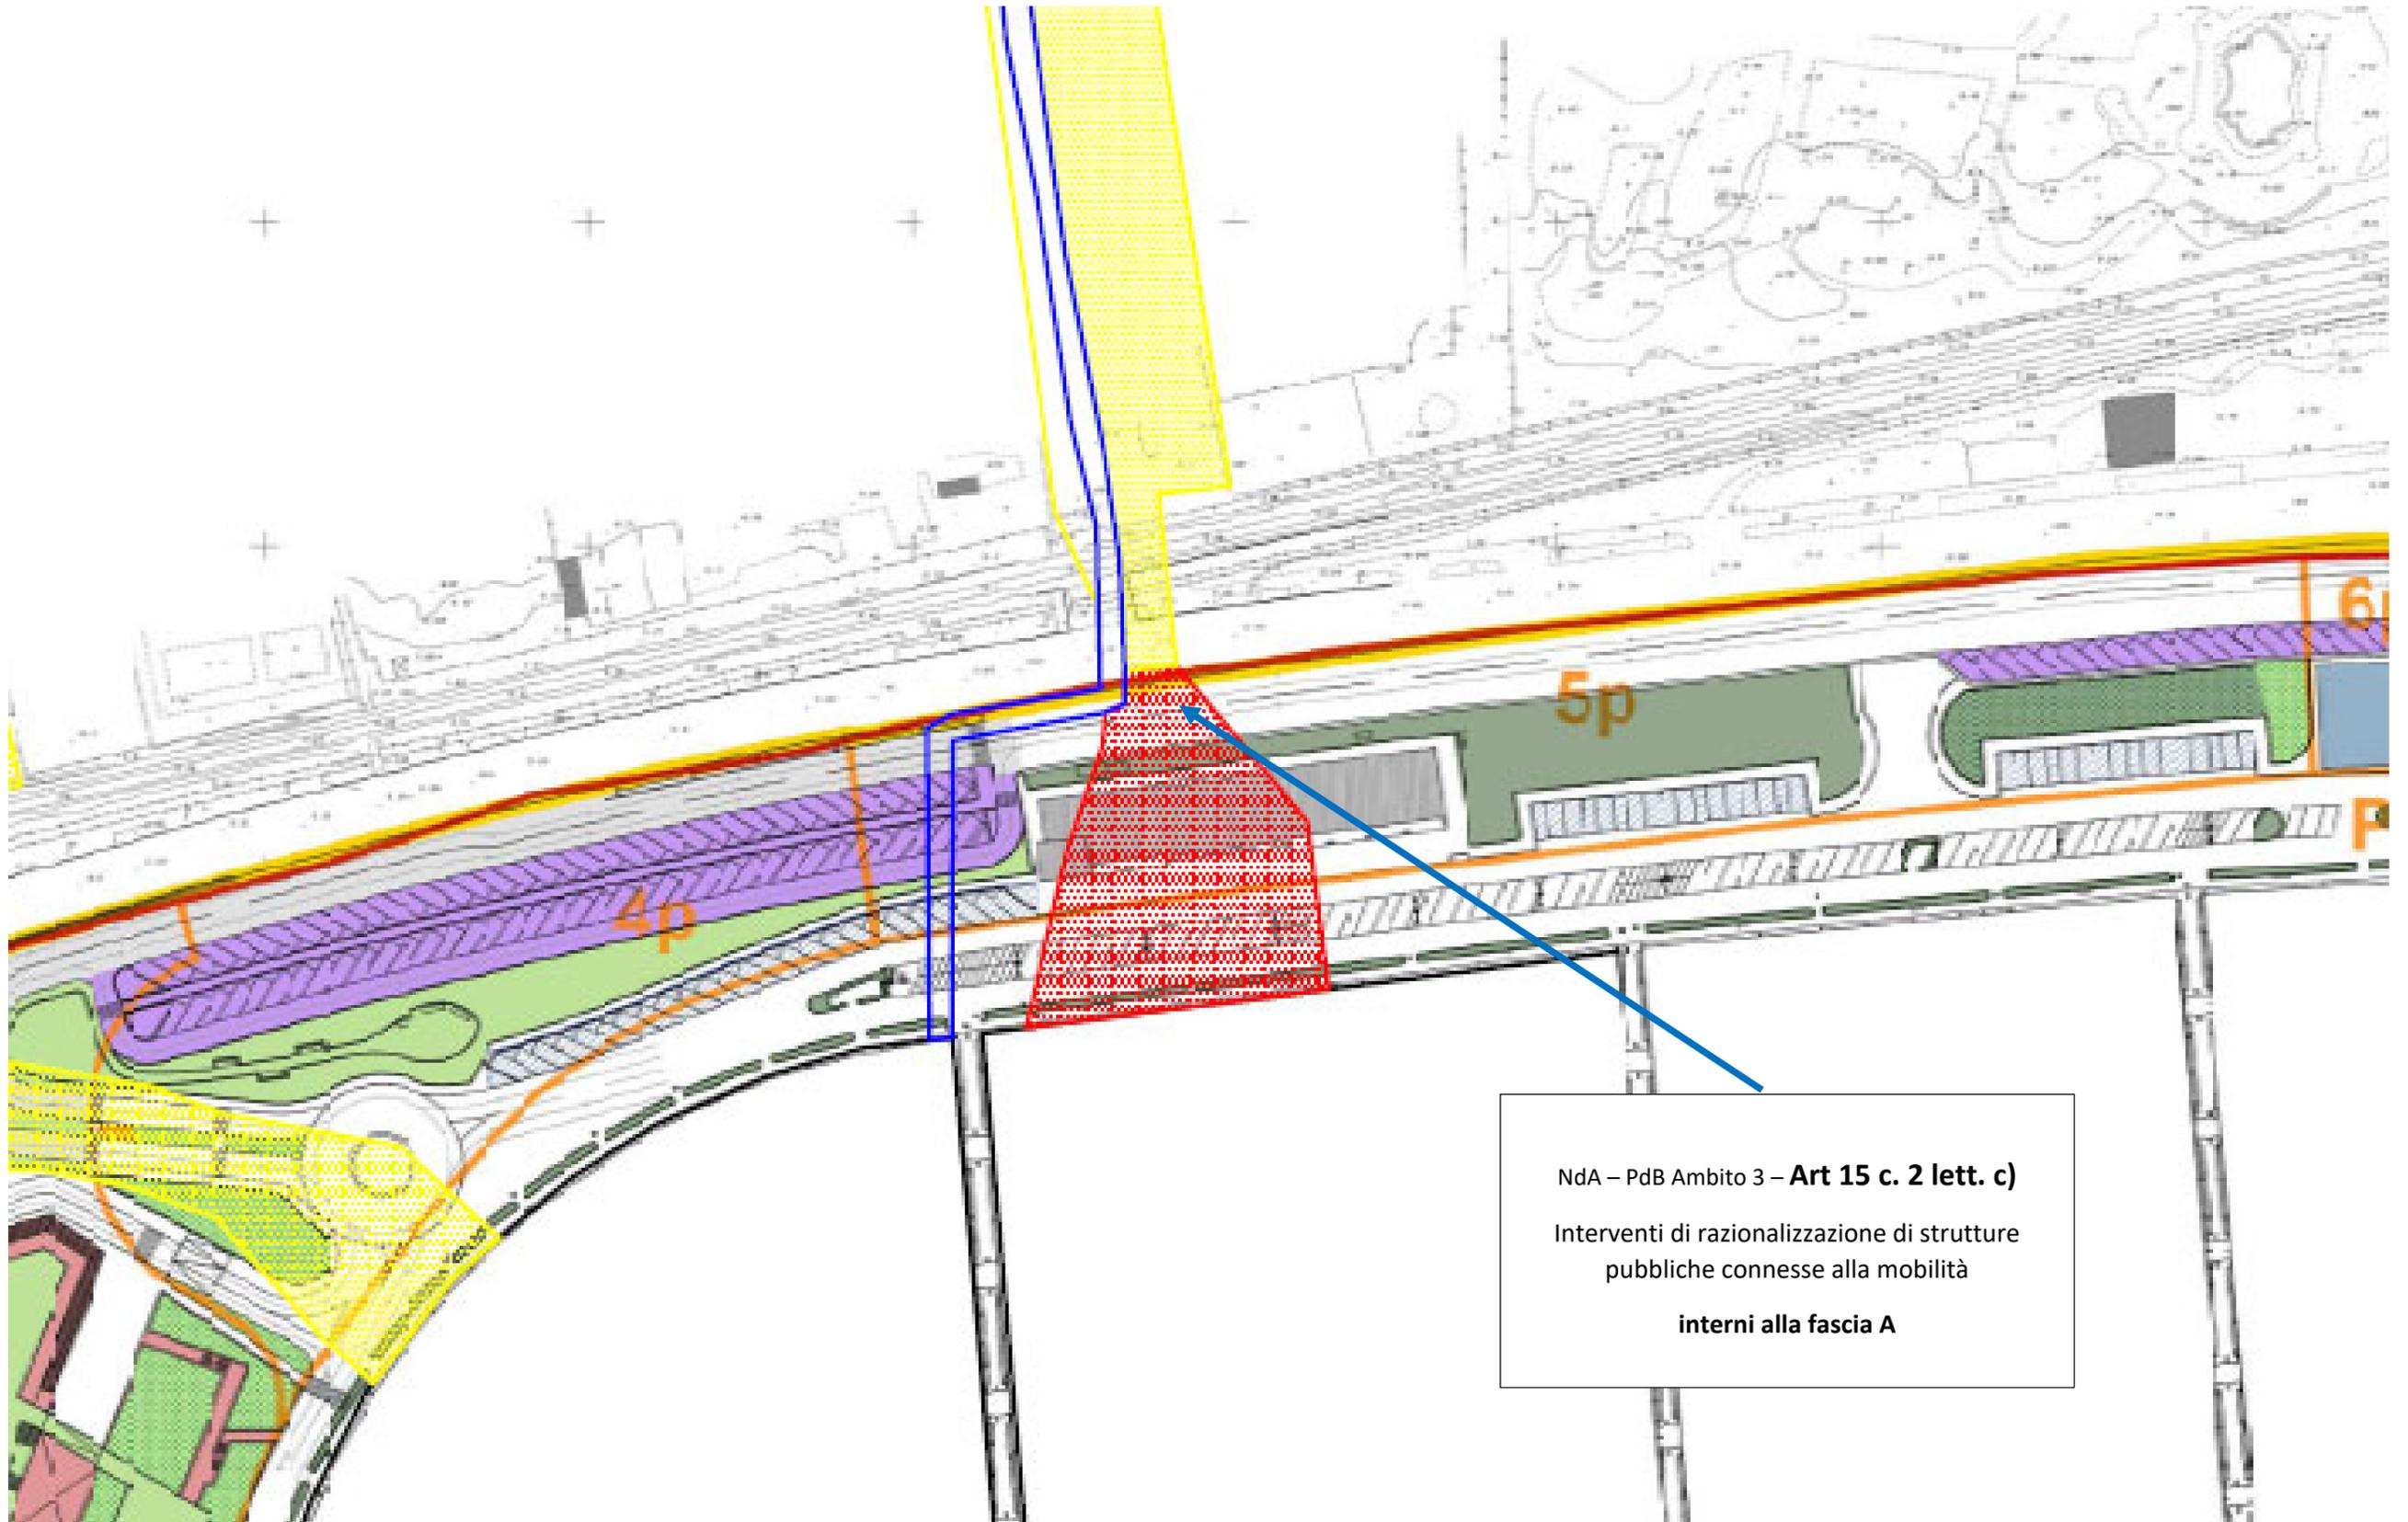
Particolare dello stato di progetto con la sovrapposizione delle fasce di inondabilità del Torrente San Lazzaro
